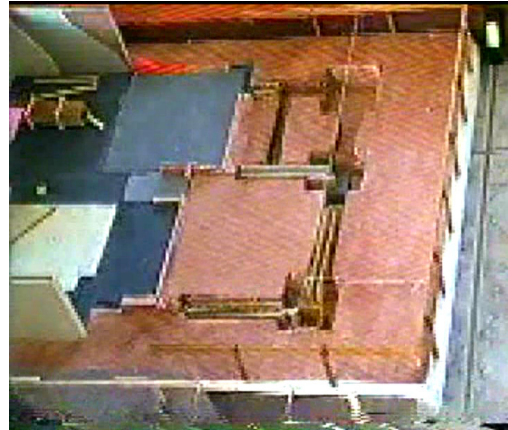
Miniatura apresentando o gabarito para locação dos blocos de fundação com viga baldrame em execução e pavimentação
